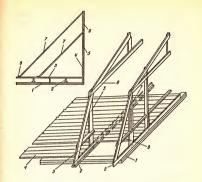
Схема крепления стропил при монтаже: 1 — брус верхней обвязки: 2 — балка перекрытия; 3 — доски иастила; 4 — стойка; 5 — стропильная иста; 6 — ферма; 7 — подкос; 8 — упор
